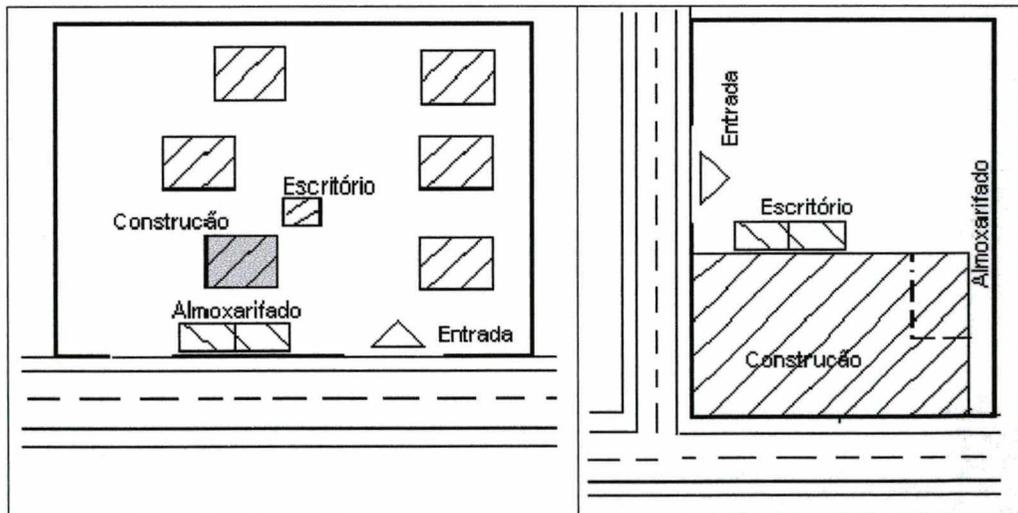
Layout* do canteiro de obra das lajes com vigotas pré-moldadas 1 e 2 respectivamente.
